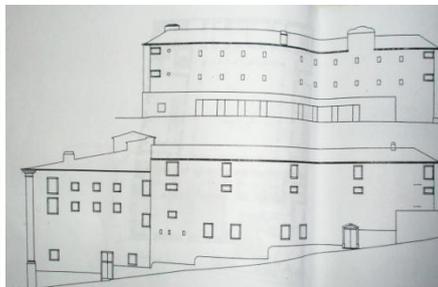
Proposta para as fachadas Norte e Nascente
